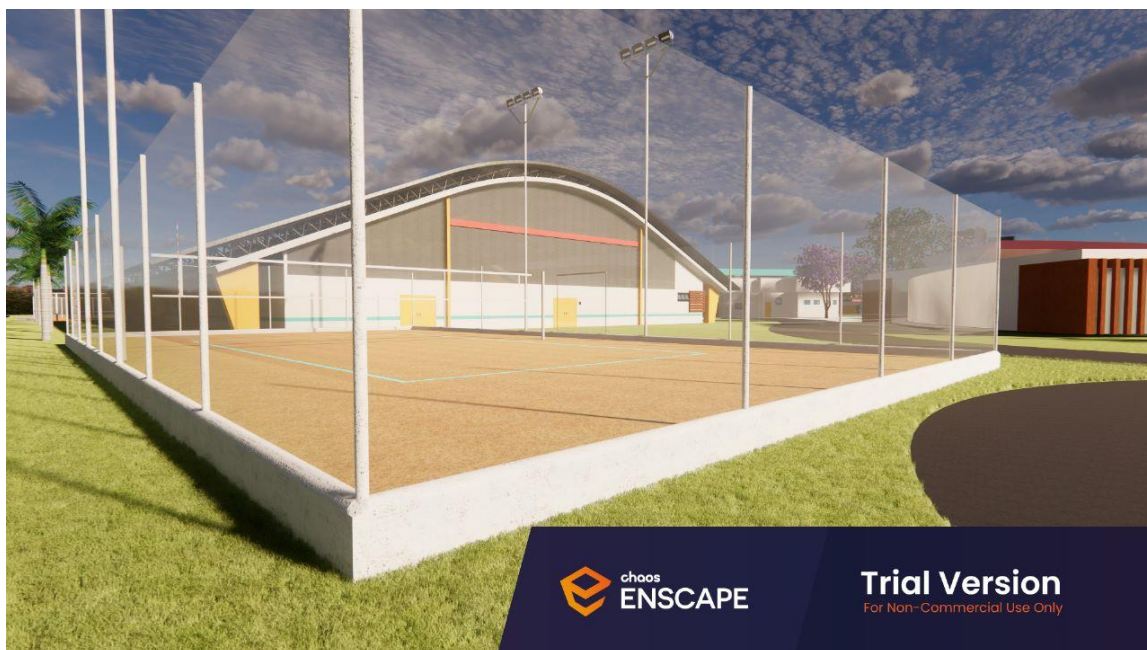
FOTOS PROJETO: Fachada da Quadra de Vôlei de Praia.
